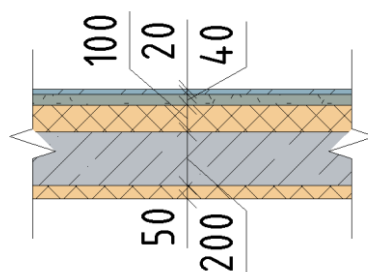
Конструкция плиты перекрытия над подвалом
